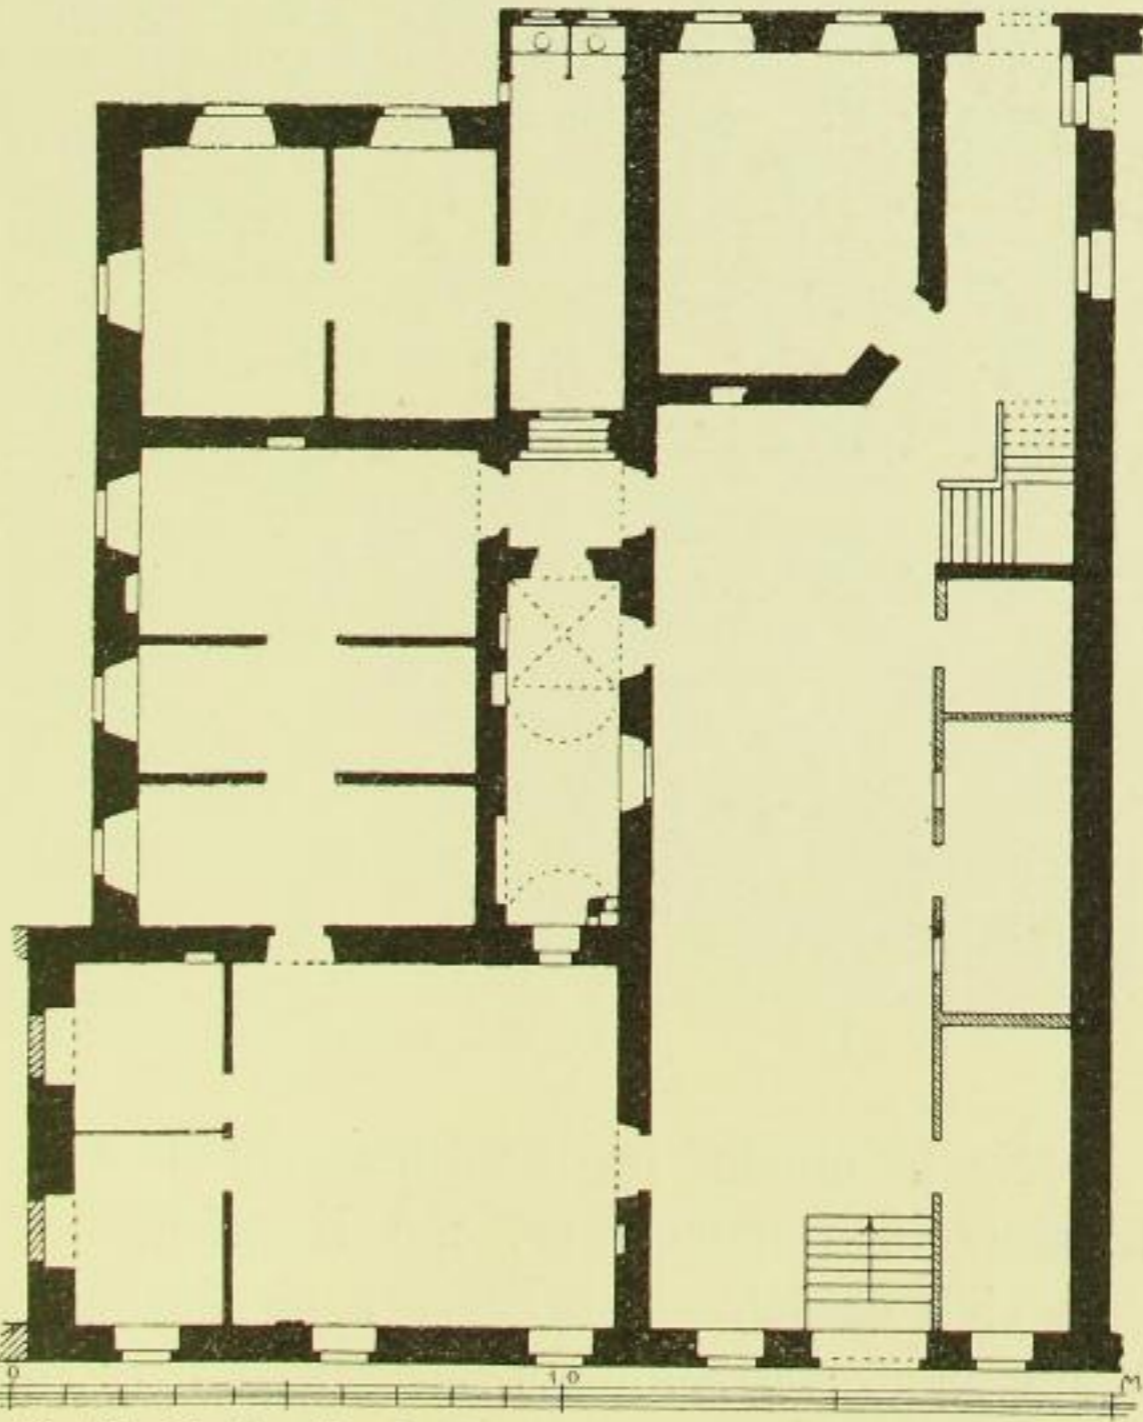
Marien-Marthenhospital, Grundriß des Erdgeschosses.
